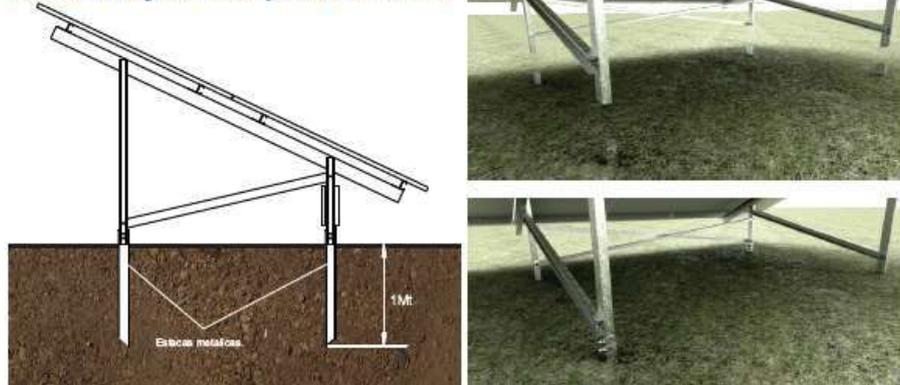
Ejemplo estructuras de soporte de paneles. Fuente: Fabricante IderoSolar (2024)
